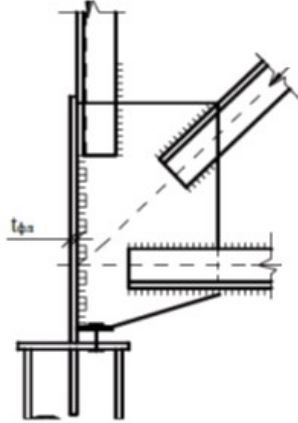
Схема шарнирного опирания фермы на колонну
